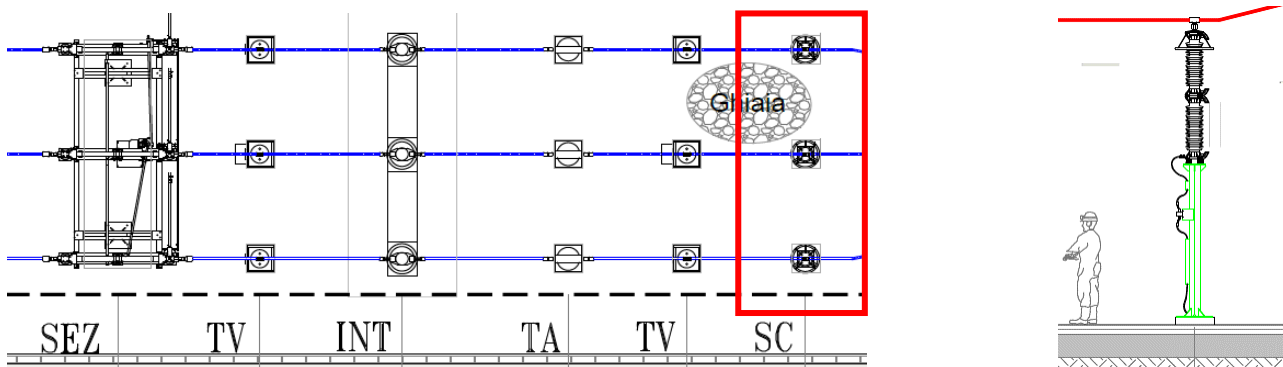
Tipico scaricatore di sovratensione – vista prospettica e planimetrica
